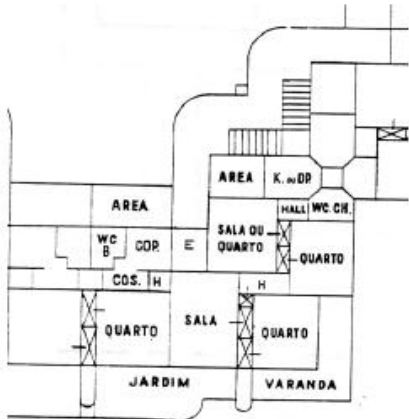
Planta de um apartamento do IAPI Lagoinha
